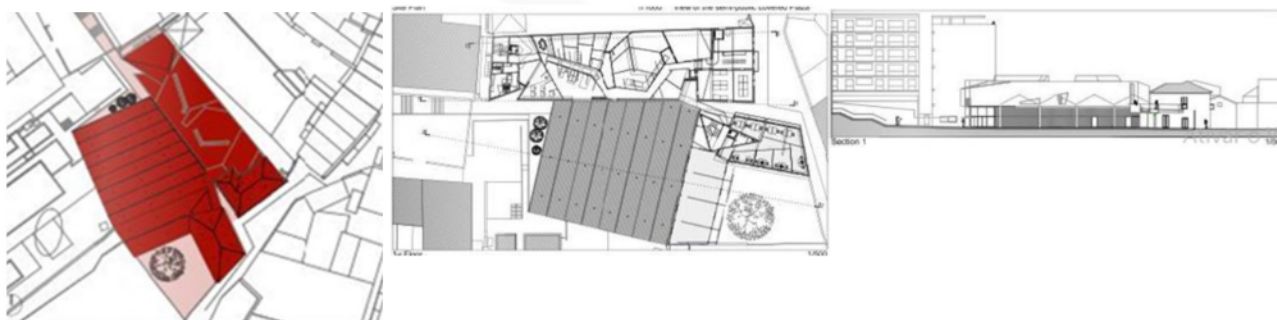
Situação, planta e seção do projeto de reconversão do Curtume da Ramada em Instituto de Design. Fonte: Cortesia do arquiteto José Manuel Soares, 2011.
